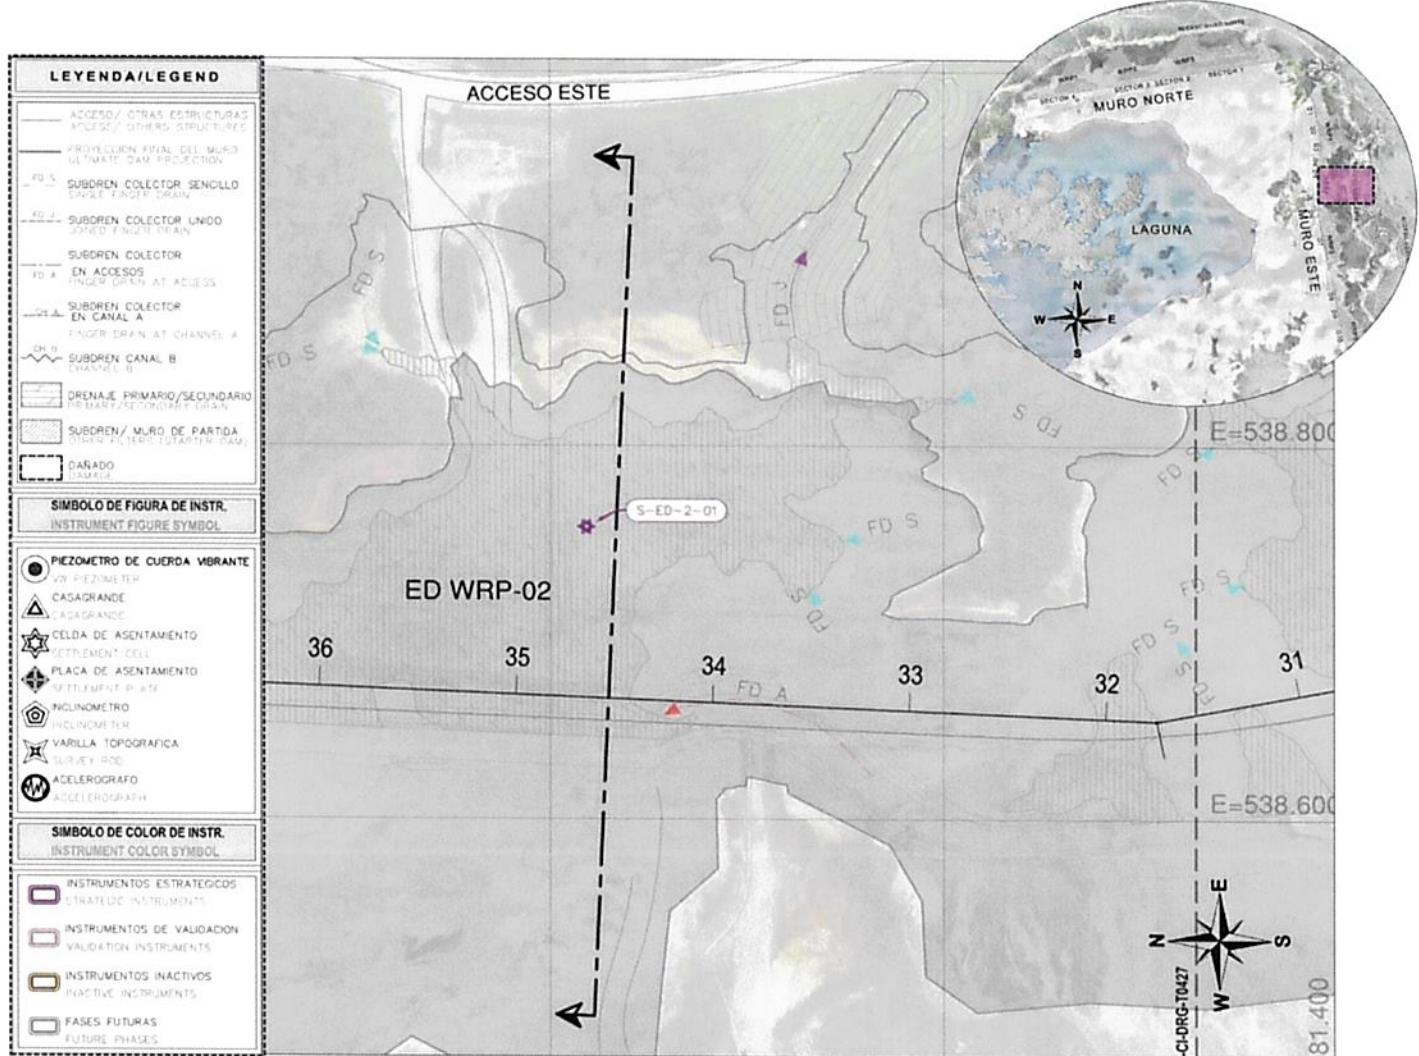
Vista de Planta en el Muro Este WRP2 con las Celdas de Asentamiento
